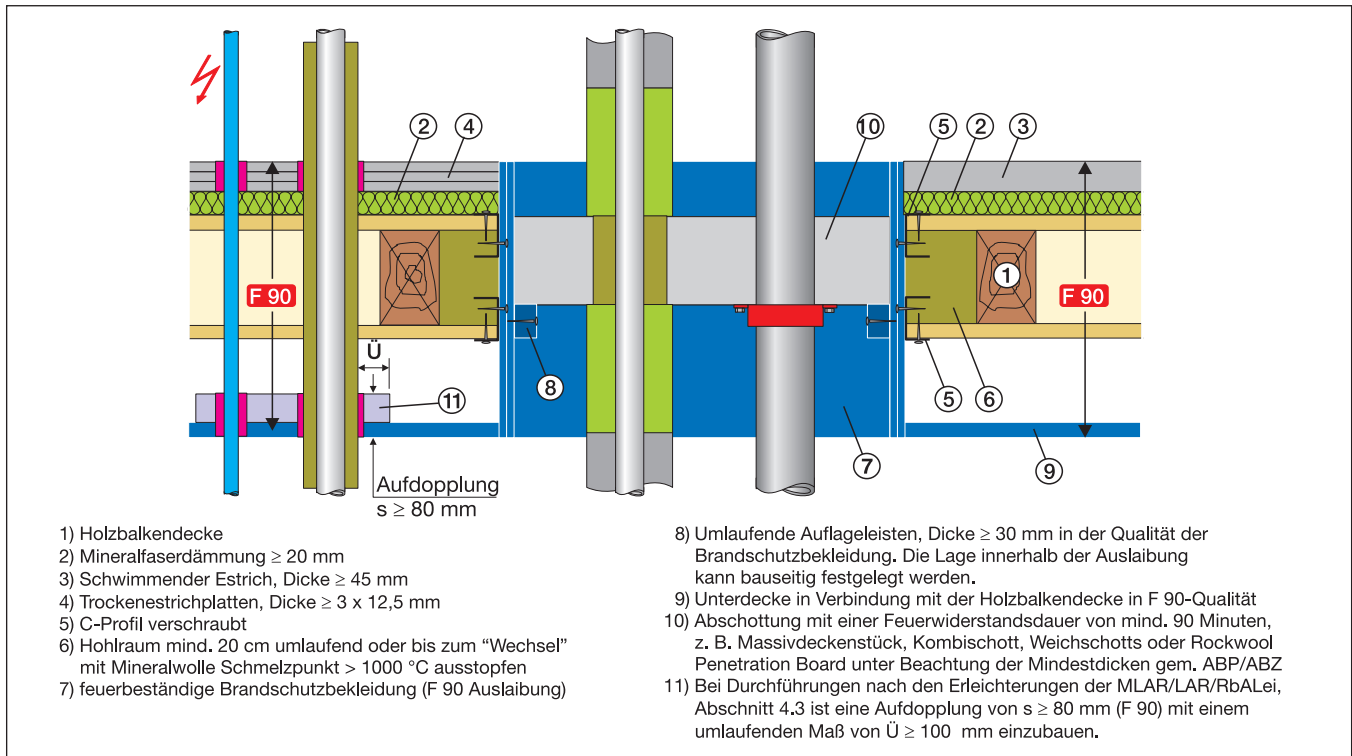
Prinzipskizze einer Leitungsabschottung / -durchführung innerhalb einer F 90-Auslaibung durch eine Holzbalkendecke mit F 90-Unterdecke (Gesamtkonstruktion = F 90) in Anlehnung an die Holzbau-Richtlinie.
